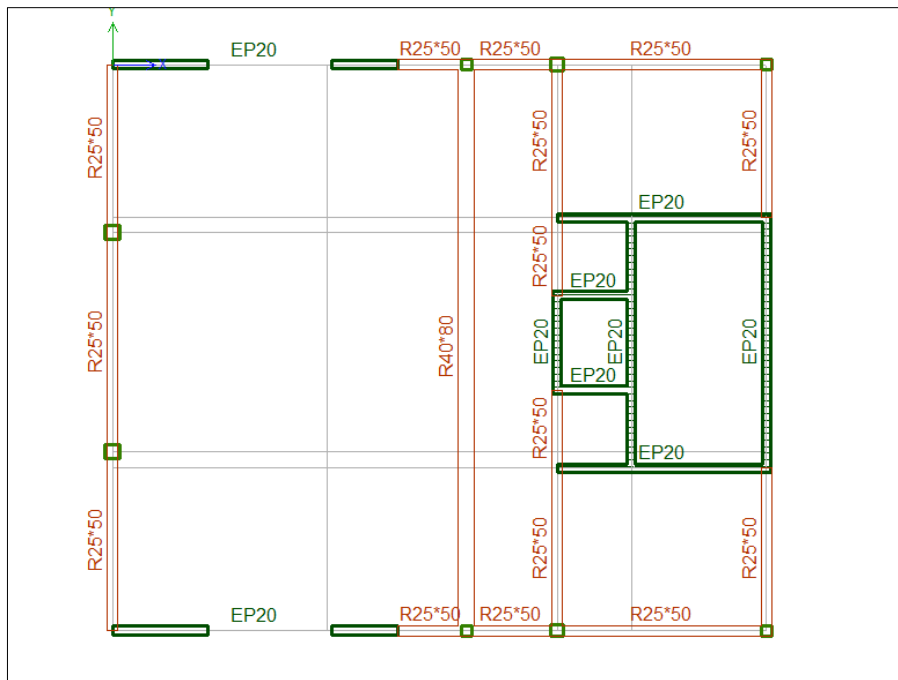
Pré-dimensionnement des voiles et poutres du RDC, Bloc 2, Tranche 1.
